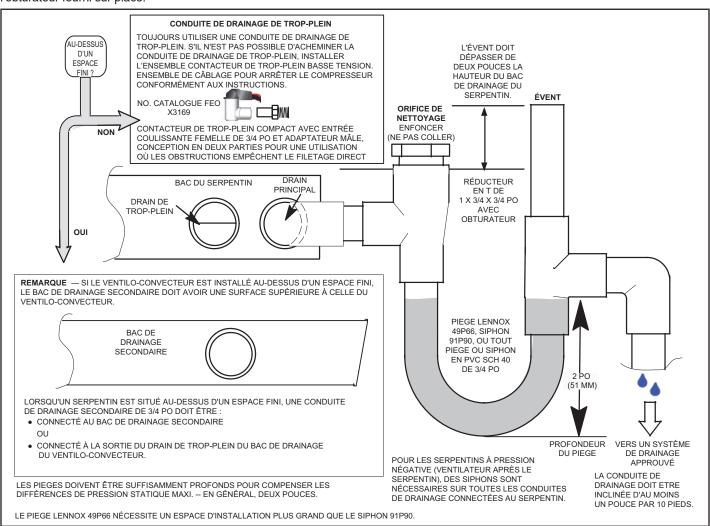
Installations typiques d'un drain principal et d'un drain de trop-plein
